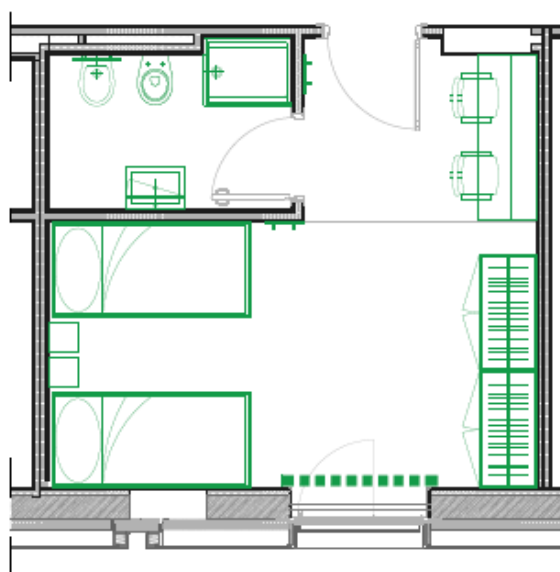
Pianta tipologia Altair - Fonte: archivio In-Domus
